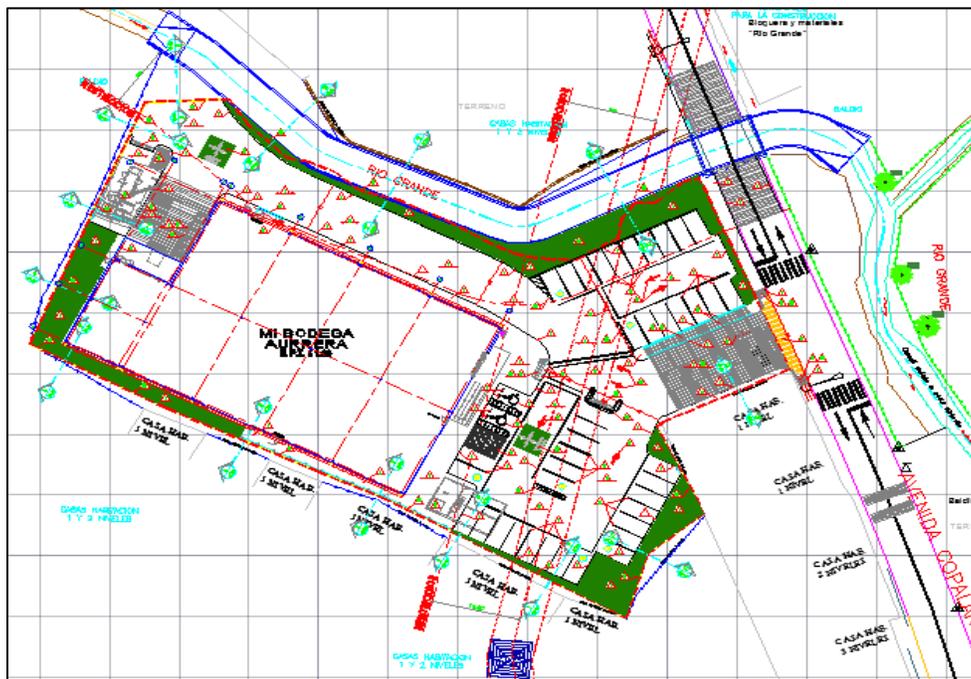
Planta arquitectónica de la tienda comercial y su ubicación con la obra de encauzamiento.
